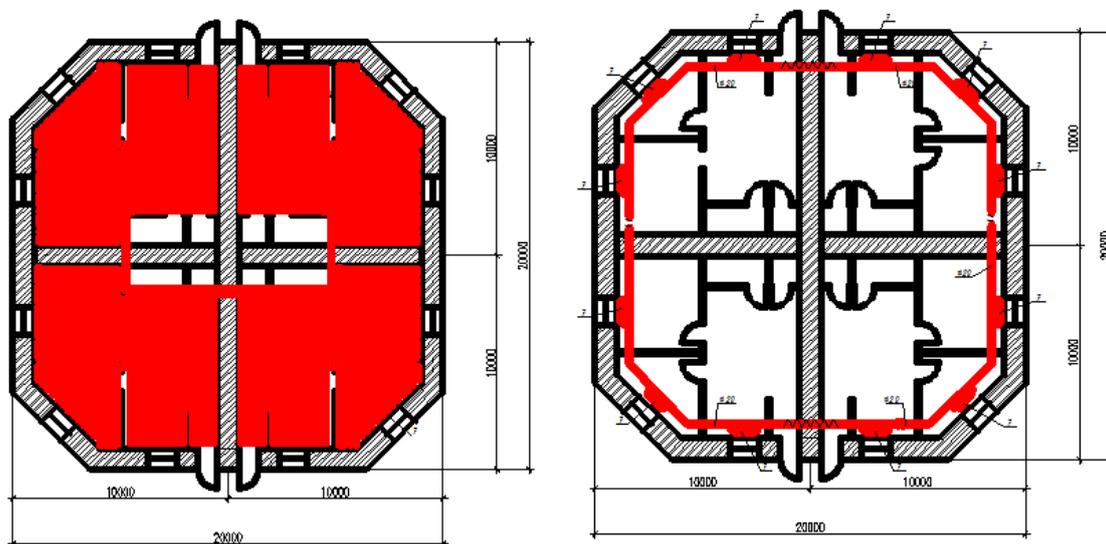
План отопления и теплого пола «Жилого дома для молодой семьи».
